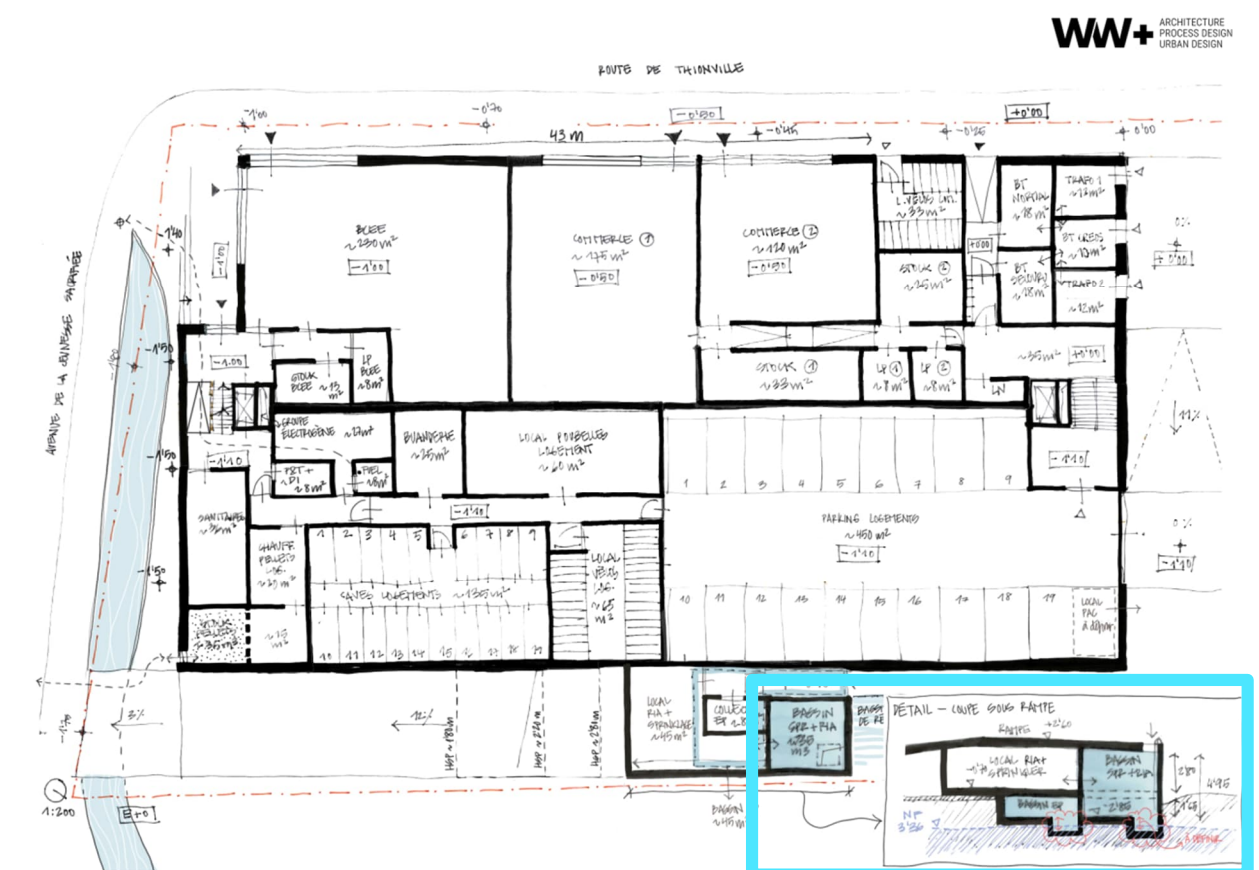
Cuve de stockage des eaux pluviales (Source: WW+)
